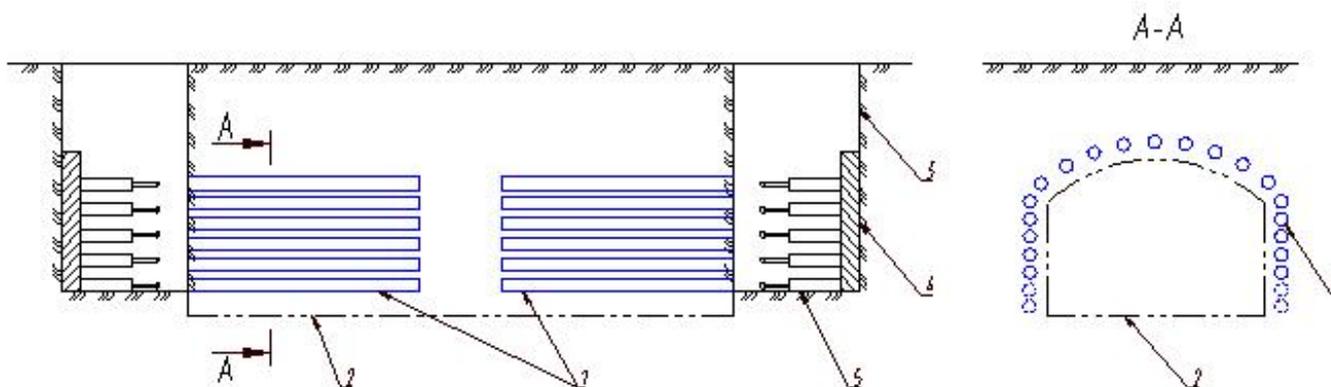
Схема экрана из труб: 1 – трубы; 2 – подземная выработка; 3 – котлован; 4 – упорная площадка; 5 – домкрат
